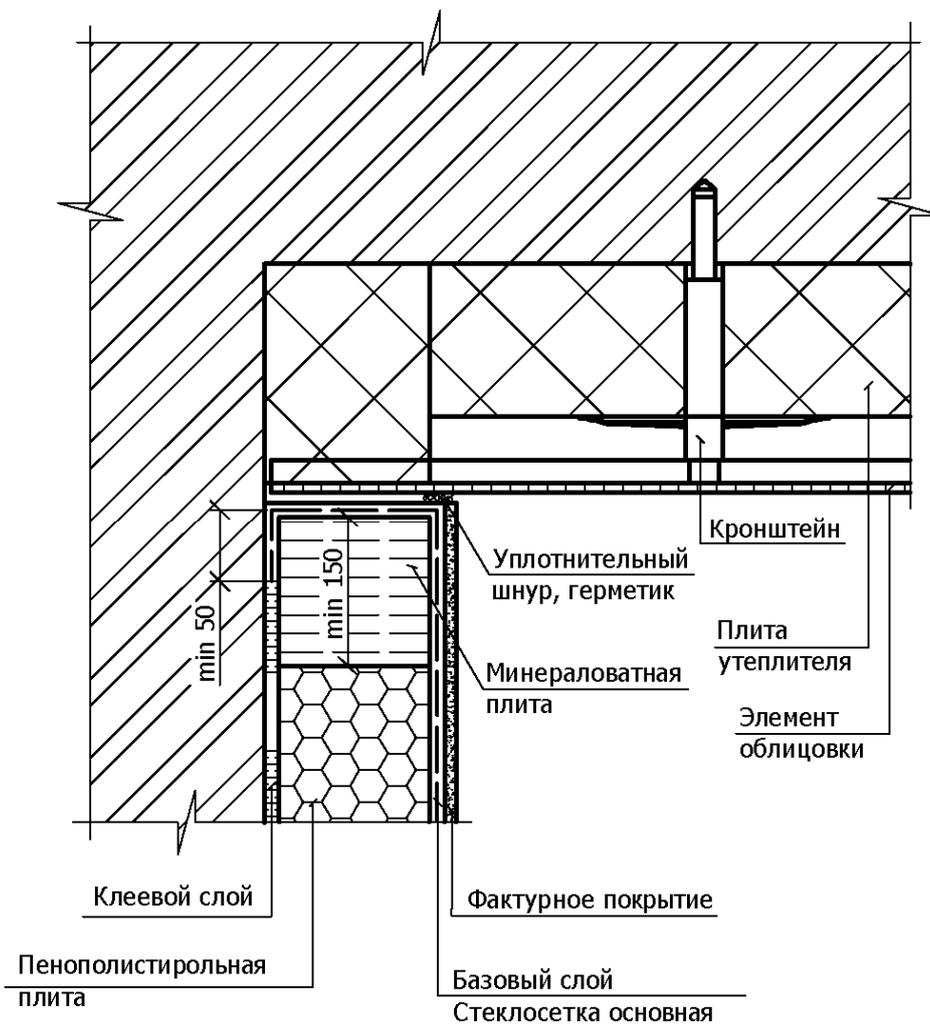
П Примыкание системы к вентилируемому фасаду на внутренних углах (вариант 2) ЛАЭС-П
